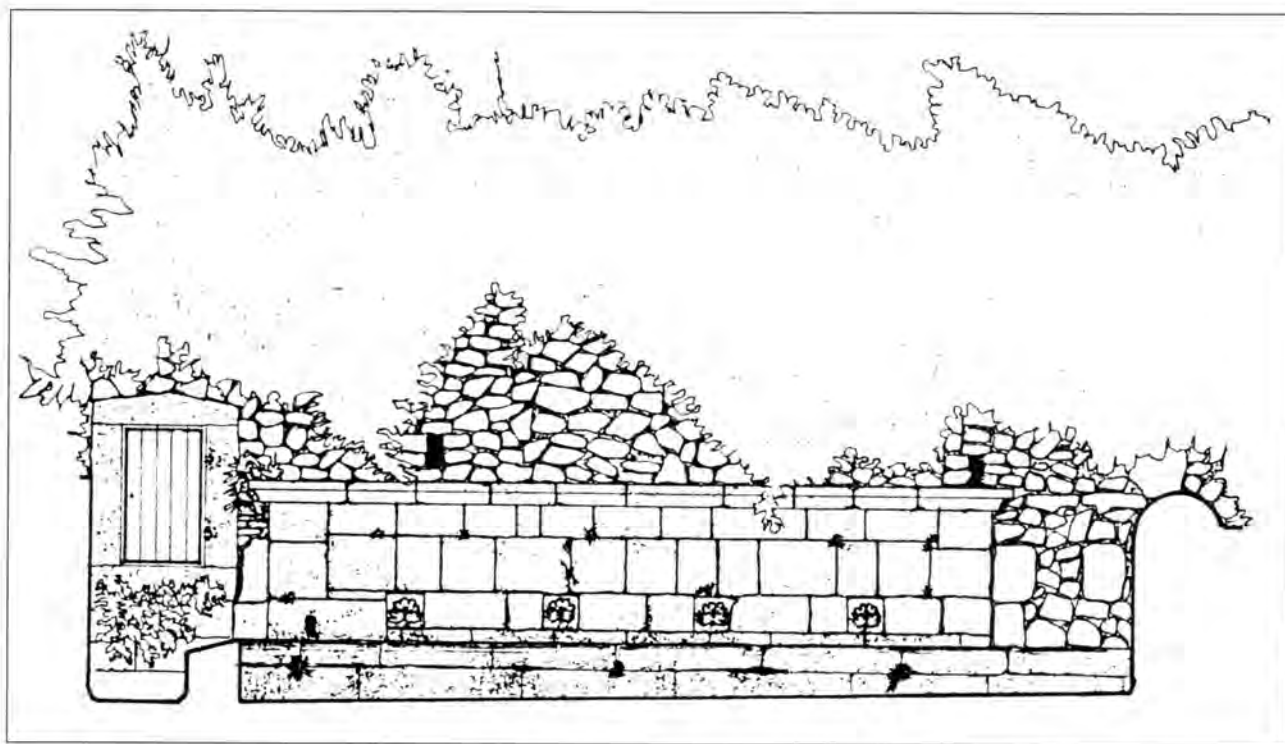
Sulmona, fonte di Santa Maria di Roncisvalle: prospetto dello stato attuale (rilievo dell'autore).
